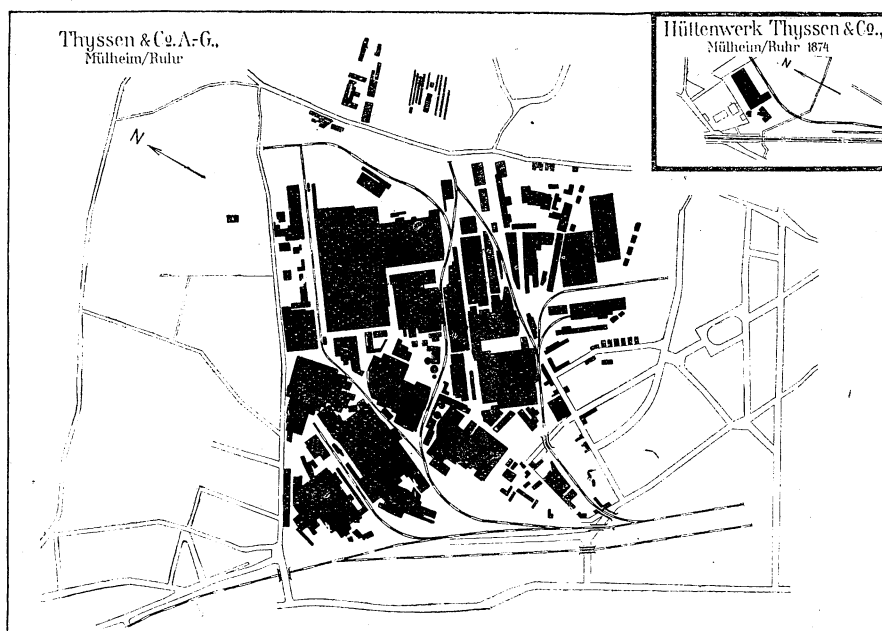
Grundriß des Mülheimer Werkes 1874 und 1921.
